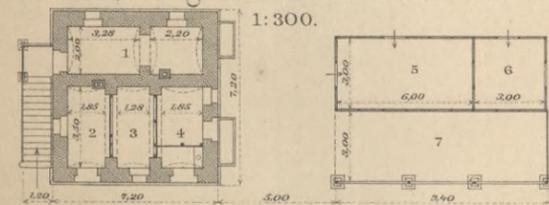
u. 9. Grundrisse des Erdgeschosses.
